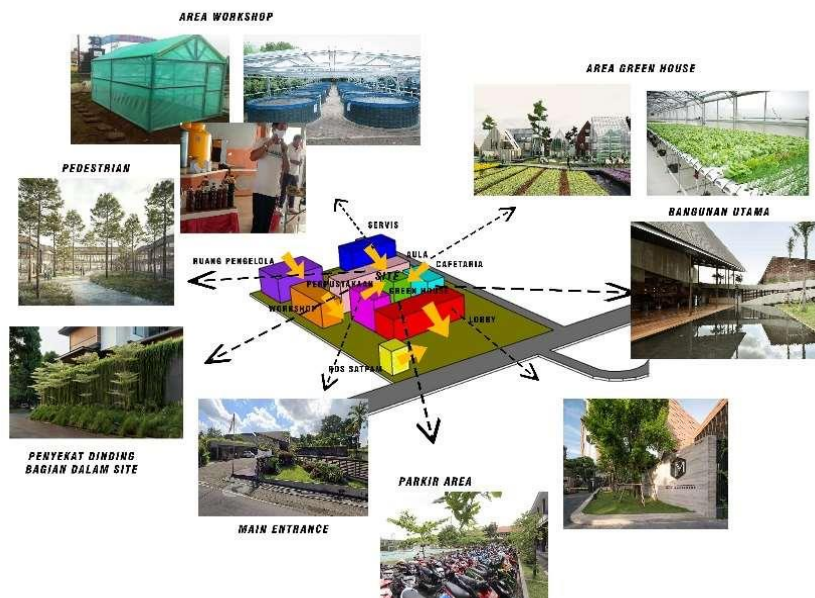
Penerapan Prinsip *Green Architecture* pada Bangunan
